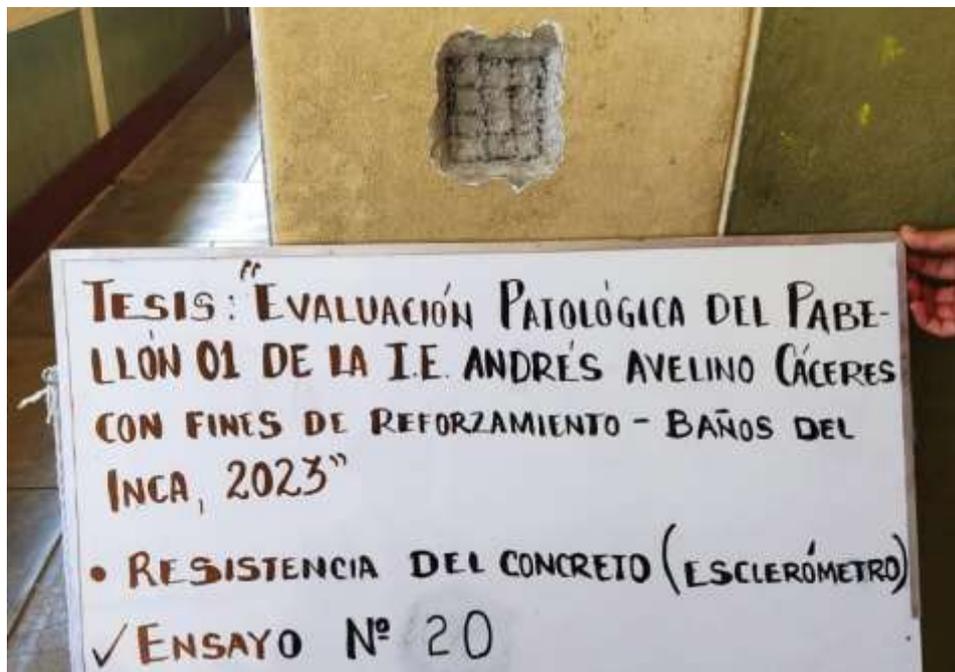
Ensayo de esclerometría en una de las losas del primer piso.
